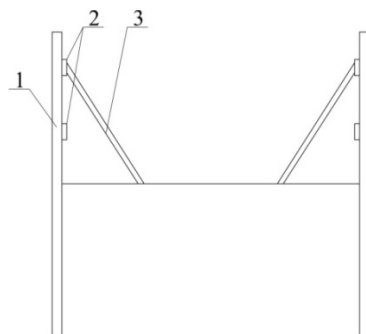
Подкосная система крепления стен глубокого котлована:
